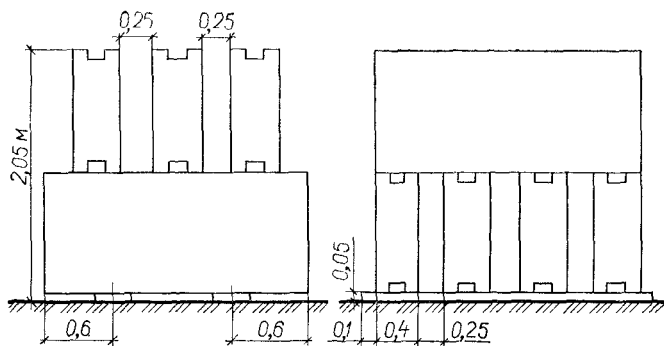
Складирование каменных стеновых блоков в два ряда на ребро на подкладках (размеры в м).
